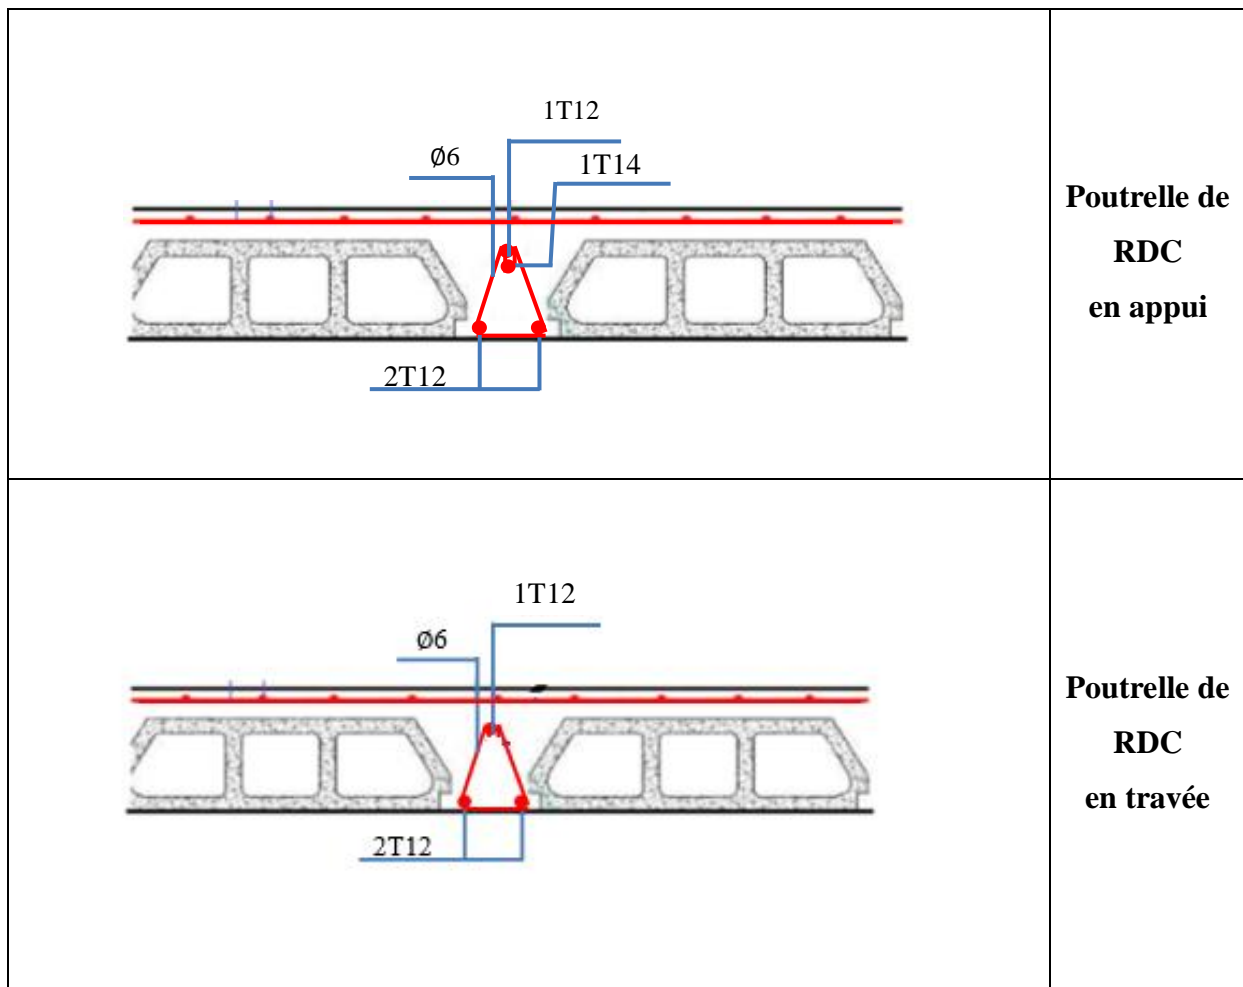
Schéma de ferrailage des poutrelles de la RDC.
